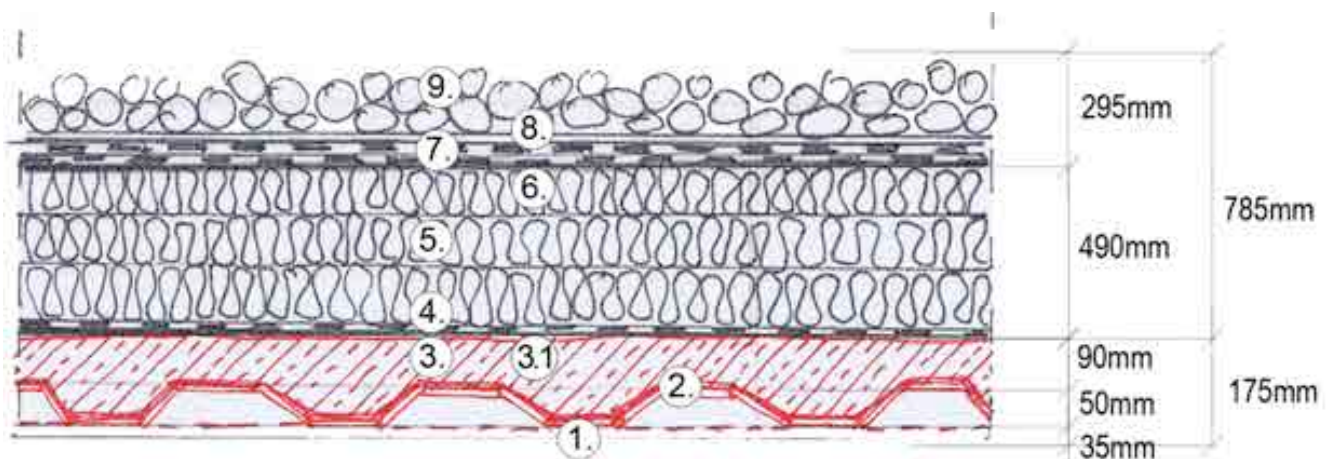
Bauteil, Dachbeläge, Decke Trapezblech
